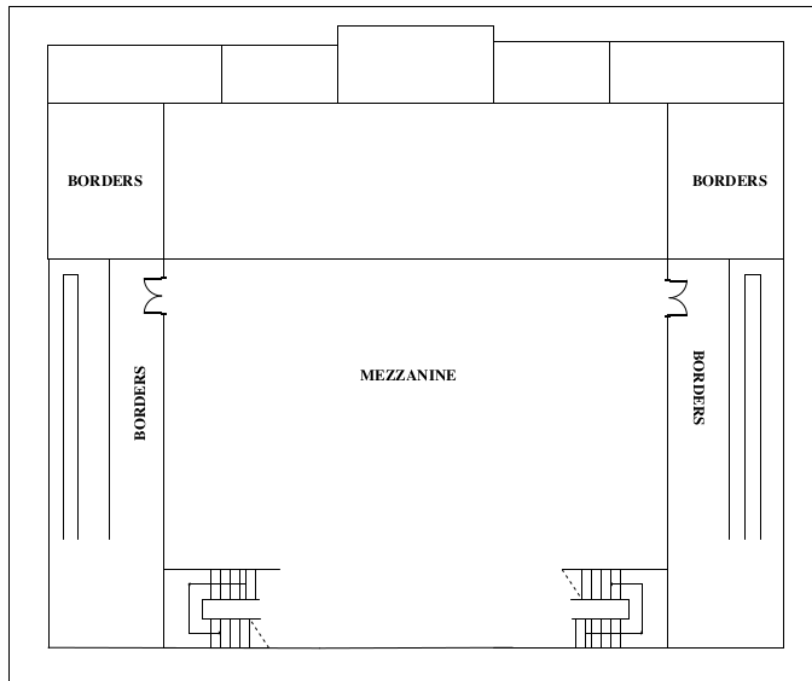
Layout Lantai 2 Gedung Student Center
